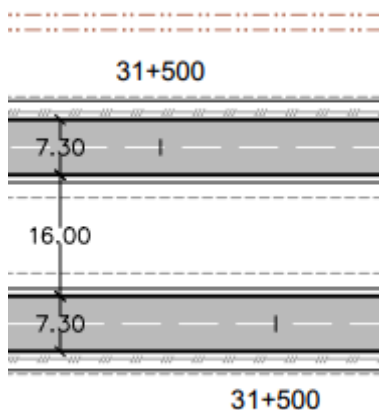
Vista en planta de autovía en progresiva 31+500
